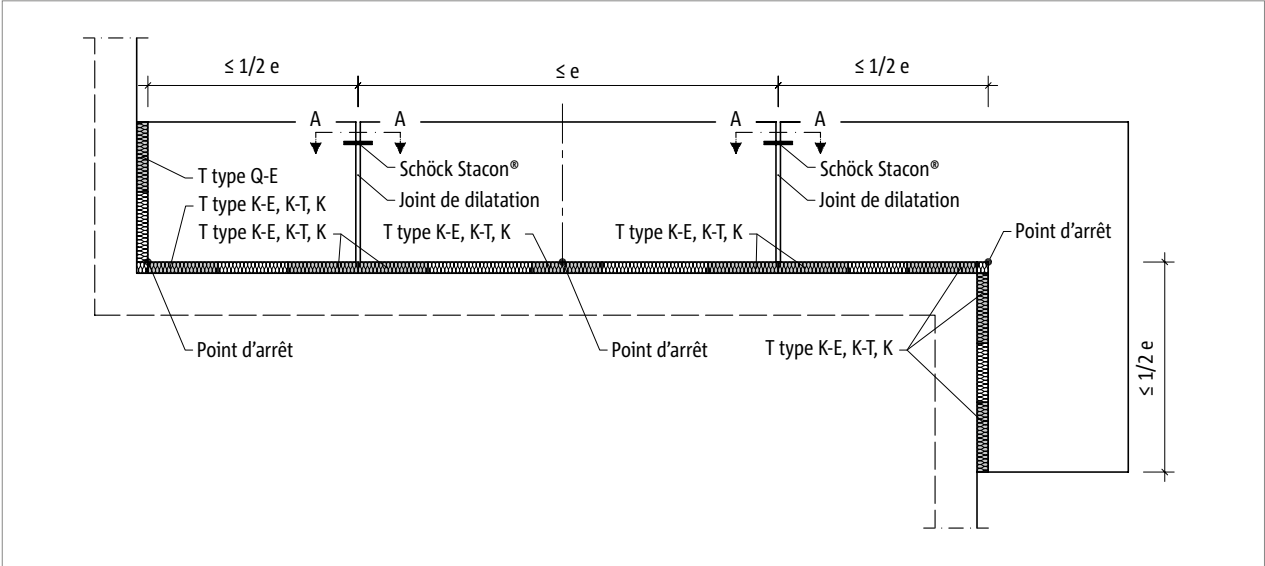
Schöck Isokorb® T Type K-E, K-T, K : Formation de joints de dilatation avec goujon pour efforts tranchants déplaçable longitudinalement, par ex. Schöck Dorn
